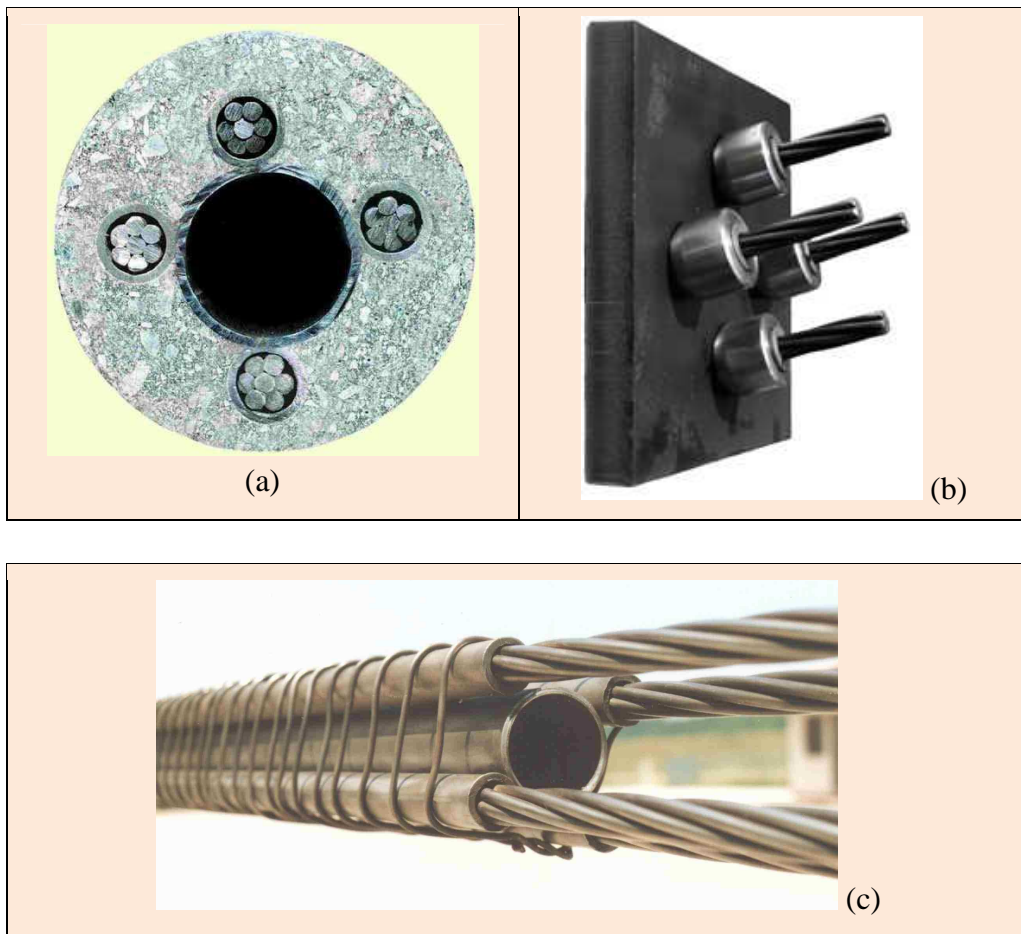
Tirante tradizionale - a) sezione trasversale, b) piastra di testata
